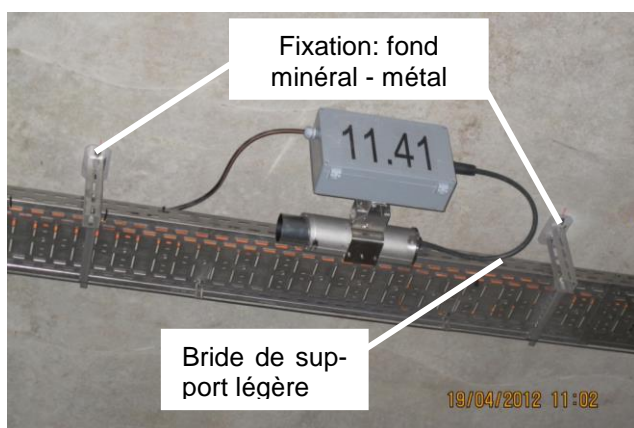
caniveau pour câbles monté au plafond d'un tunnel
